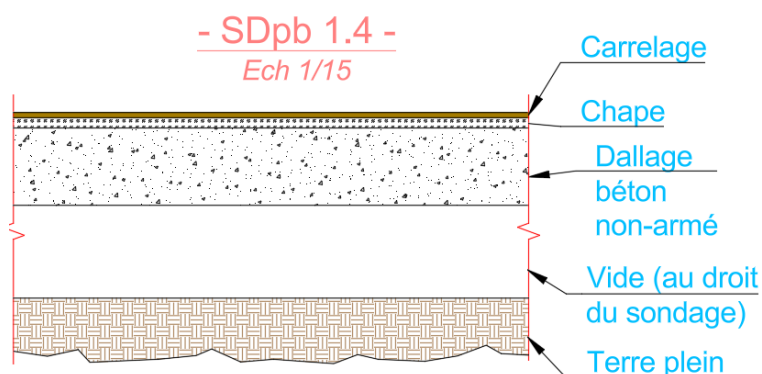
Coupe sur dallage plancher bas RDC au droit du sondage
